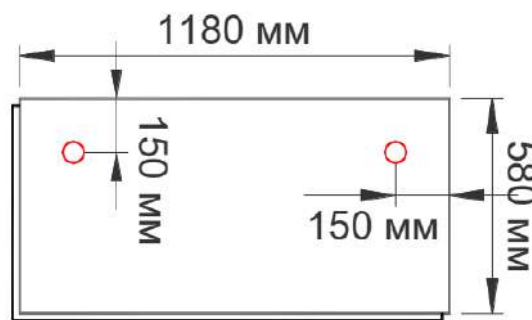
Схема кріплення теплоізоляційних плит
